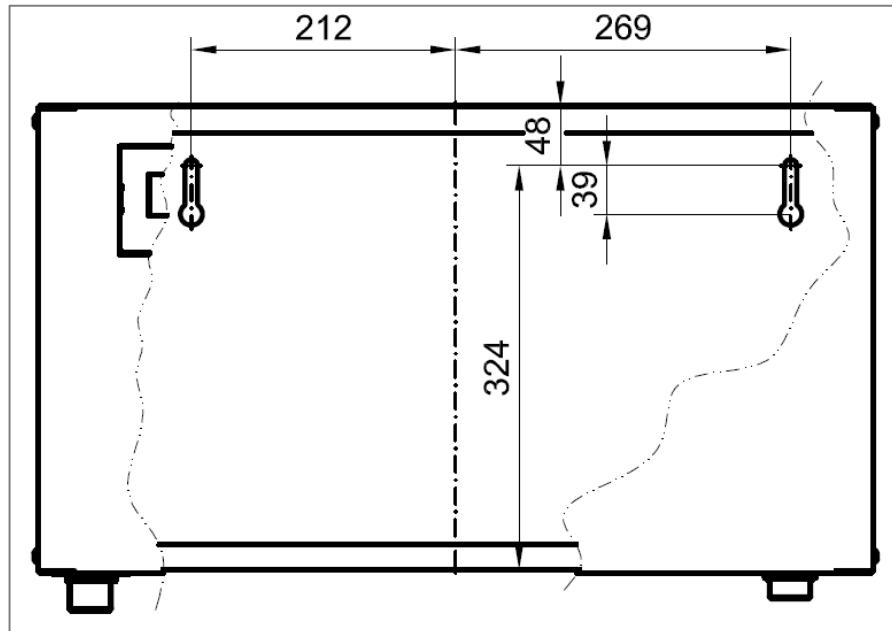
Bohrbild Kompakt-Trinkwassererwärmer
